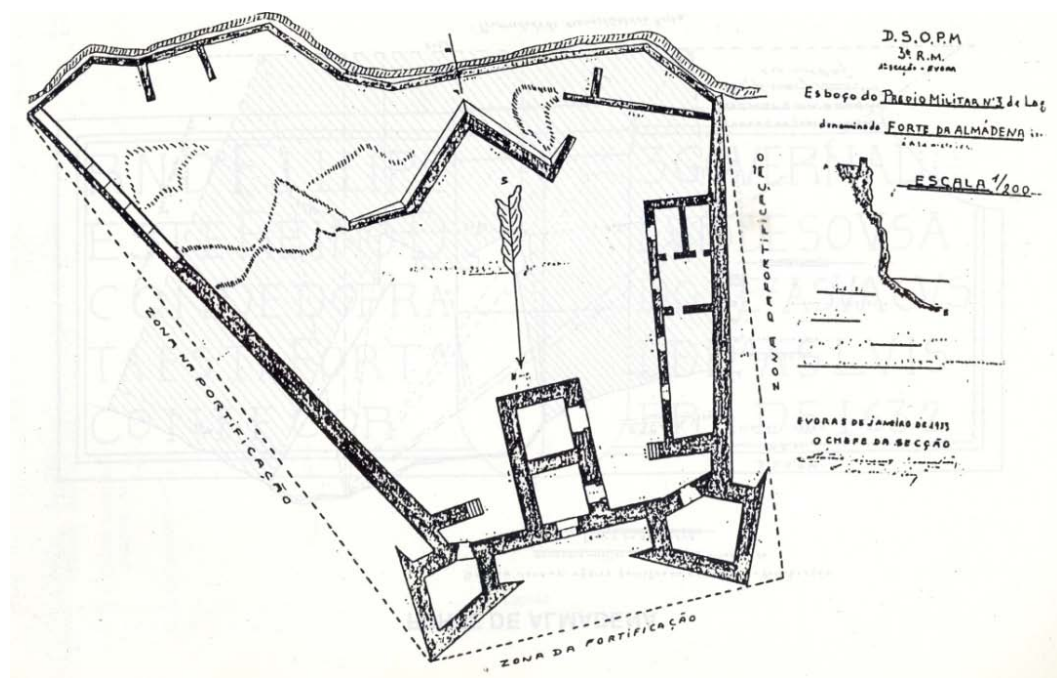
Planta do Forte de São Luís de Almádena - s/data
